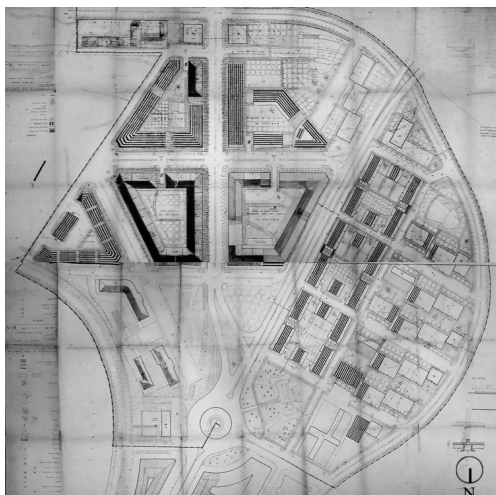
/ ENCÍO CORTÁZAR, Juan Manuel. Plan Parcial del Sector 1.3 Ensanche de Amara. 1963-1966
